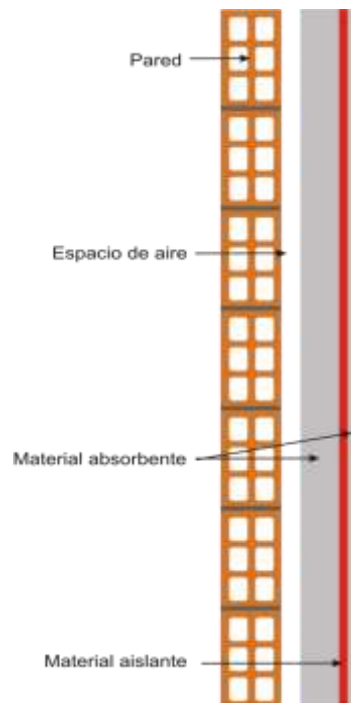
Construcción de una pared con material absorbente y aislante acústico.
